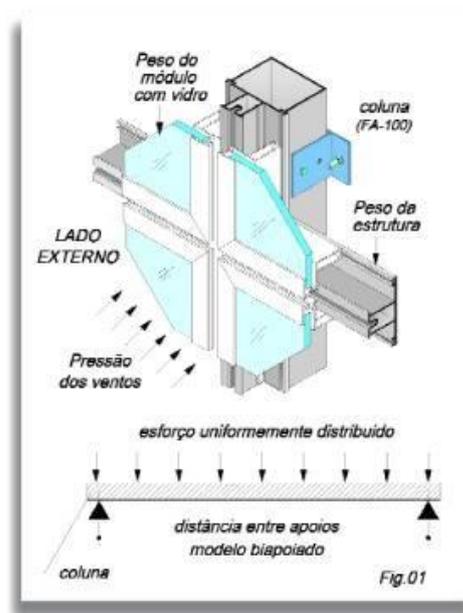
Estrutura auxiliar em cinza e quadro encaixilhado em branco.
